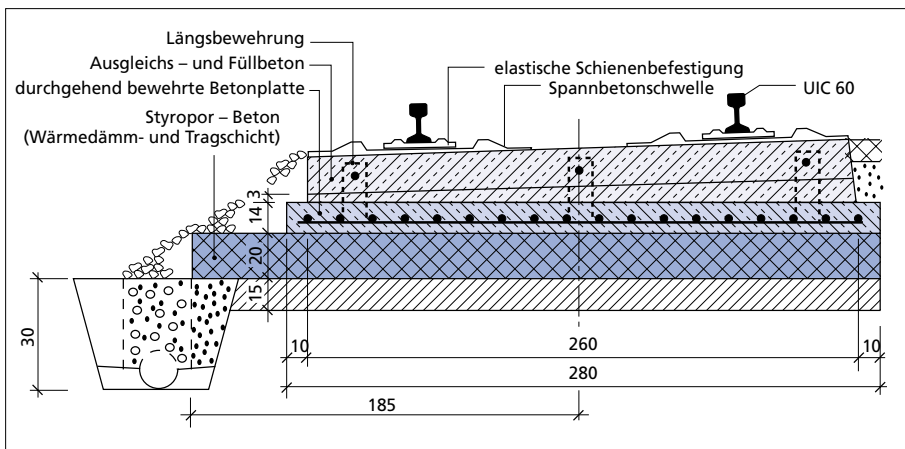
Feste Fahrbahn System Rheda, Betontragplatte mit einbetoniertem Gleisrost, gebaut 1972 im Bahnhof Rheda im Zuge der Strecke Bielefeld–Hamm
